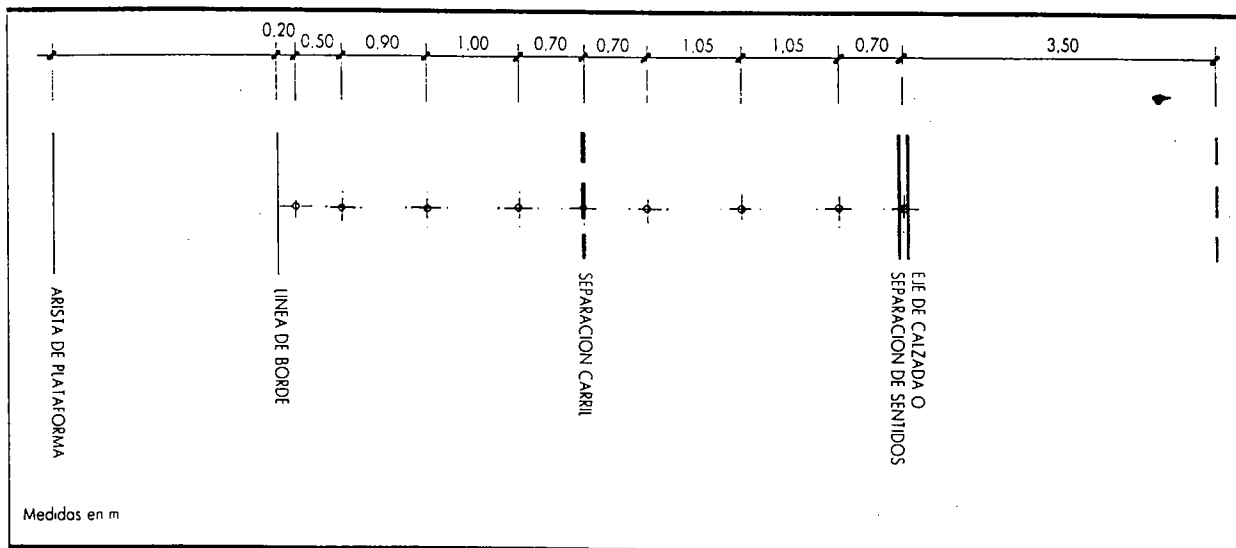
Ejemplo de distribución transversal de puntos de ensayo sobre pavimentos de carreteras.
